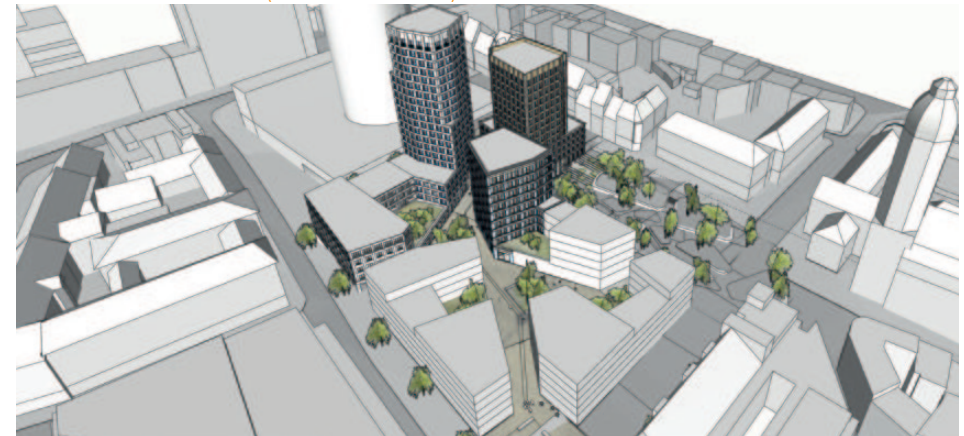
Dreidimensionale Veranschaulichung der Planung zur Orientierung (Müller-Reimann Architekten, Stand: 2020)
